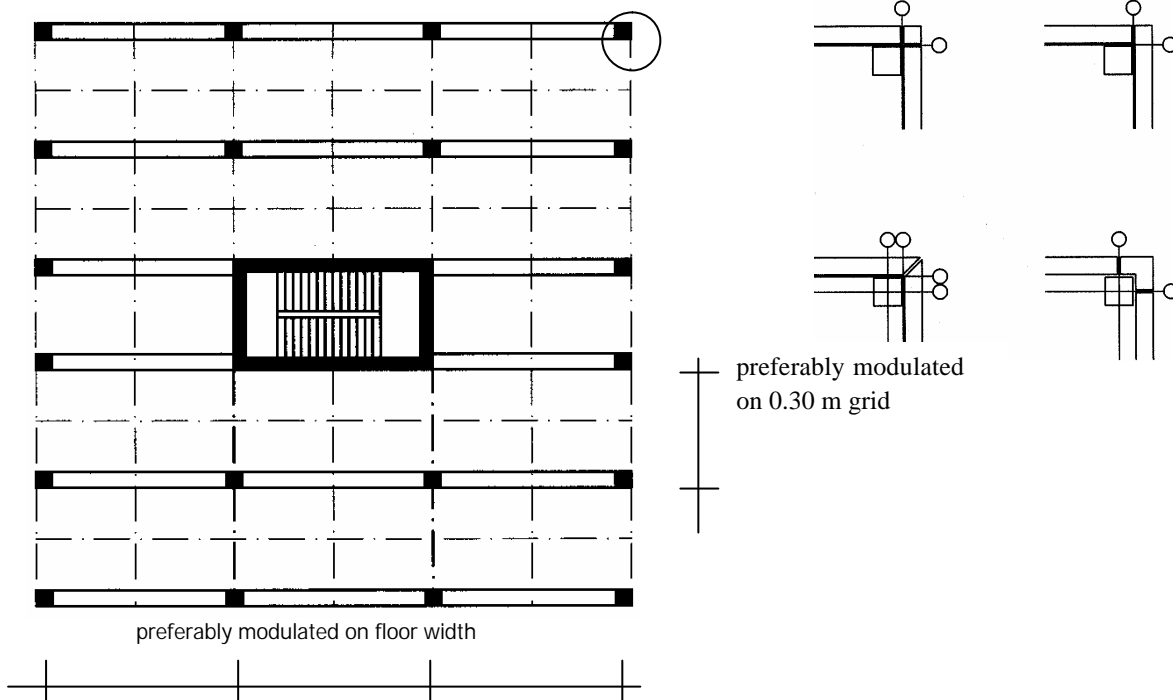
Exemplo de sistema modular para estruturas pré-moldadas
